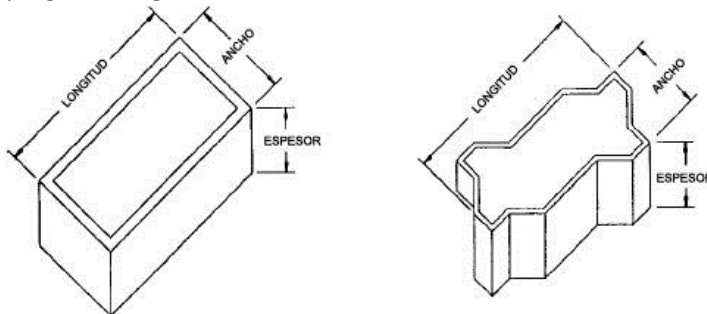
Longitud, Ancho y Espesor de las Unidades del Pavimento de Concreto.
